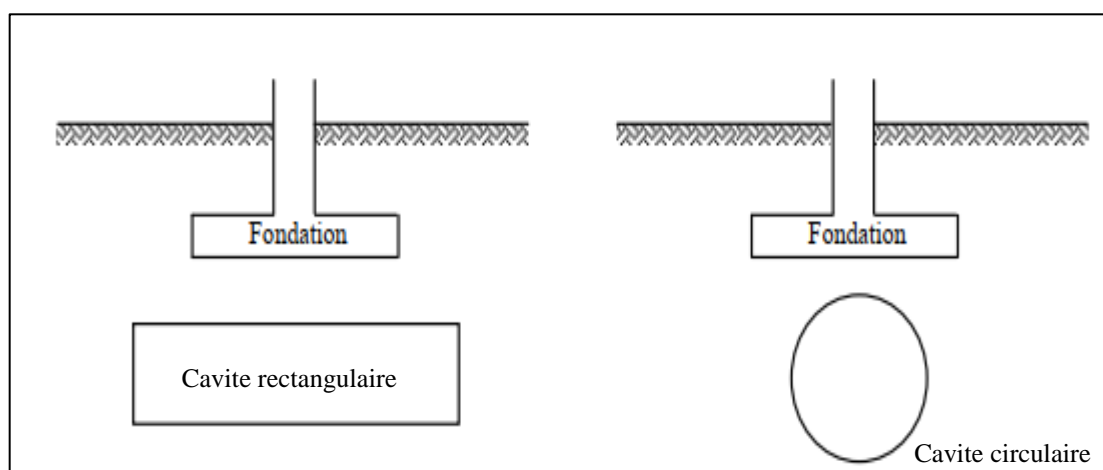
Fondation filante au-dessus d'une cavité cas étudiés par Baus et Wang. (1983).
